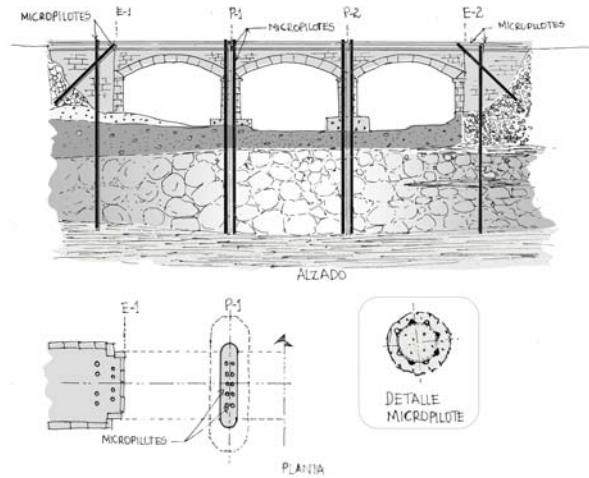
Micropilotes en pilas y estribos de puentes de fábrica.
